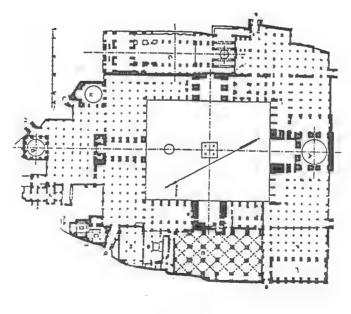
المسقط الأفقي لرباط سوسة في تونس .
